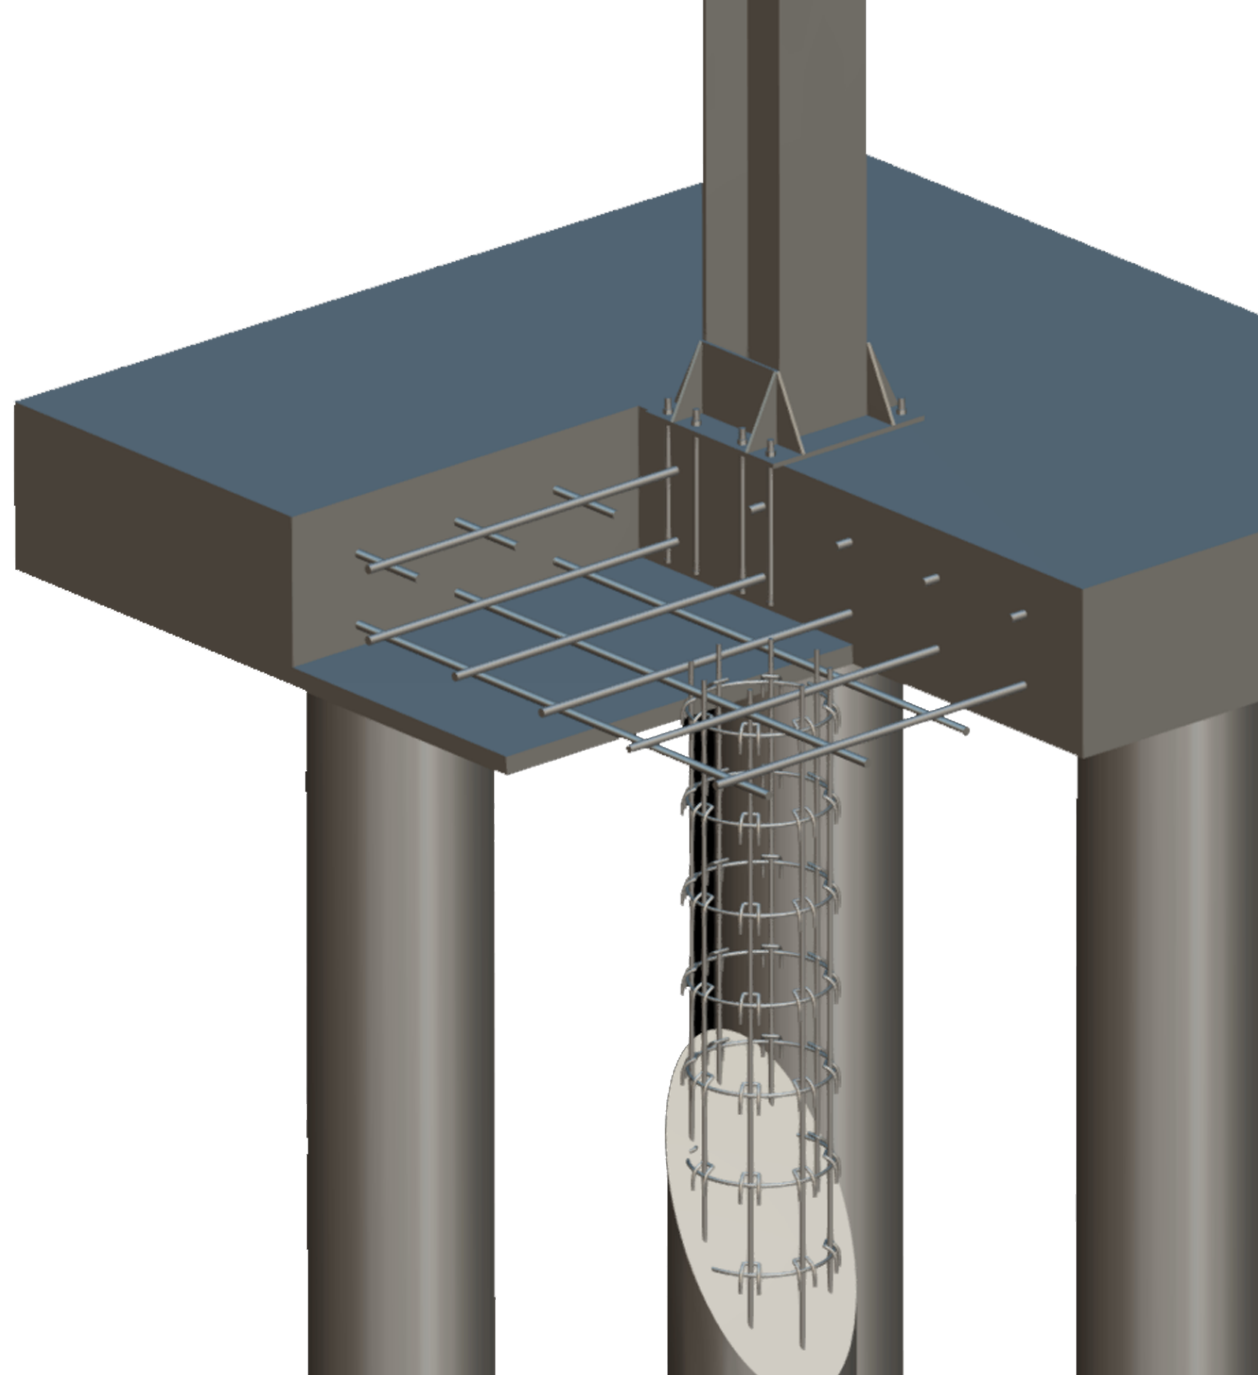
Sketchfab, 2021, Steel structure pile foundation
